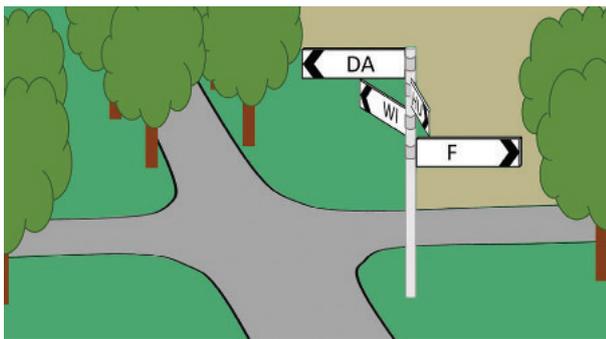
Pfeilwegweiser sind das Standardelement für einfache Knotenpunkte
